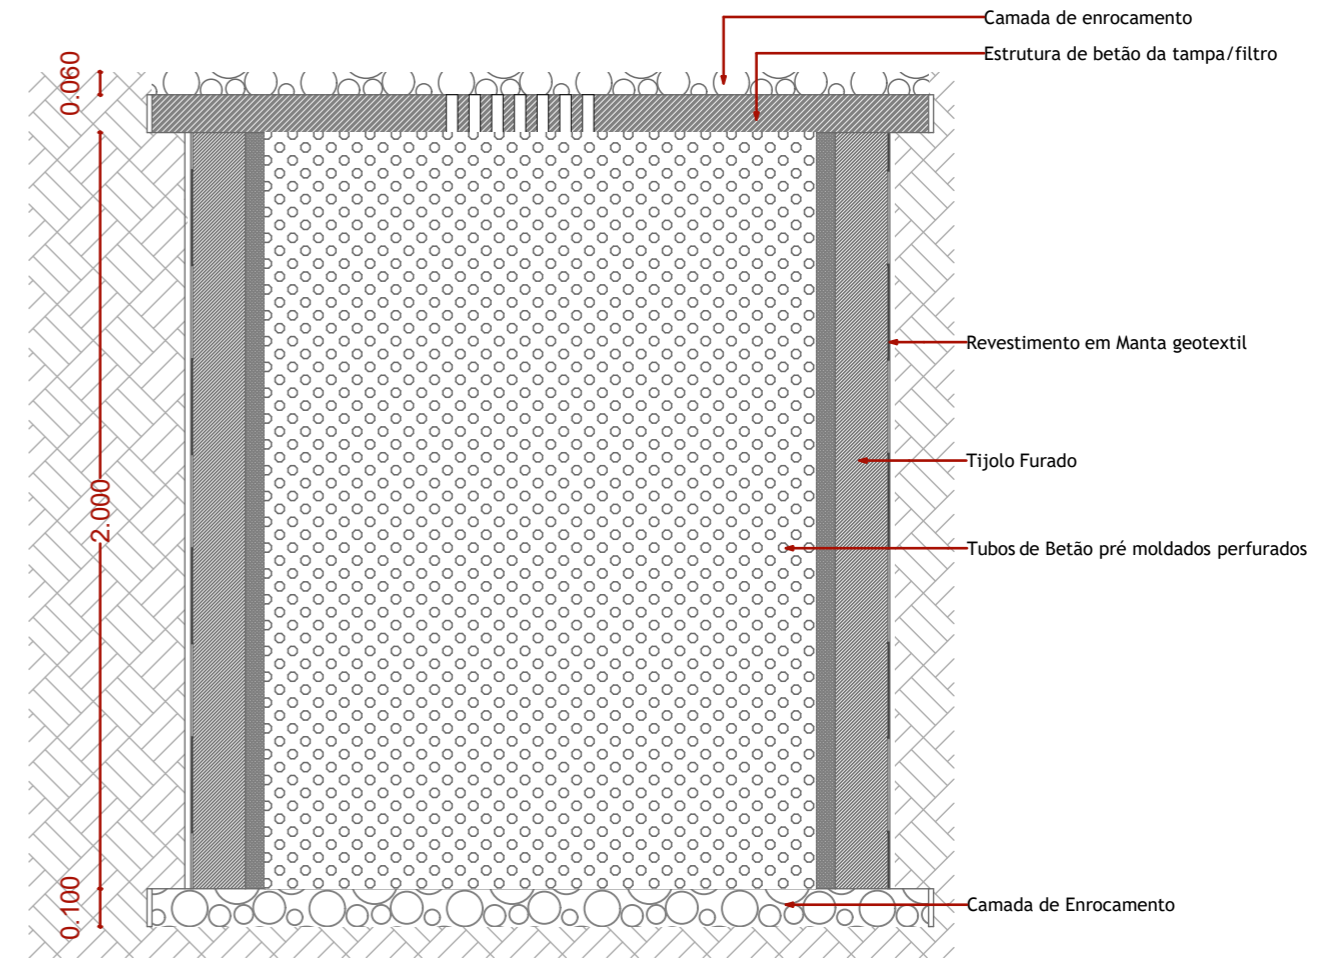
DET. CORTE POÇO DE INFILTRAÇÃO
